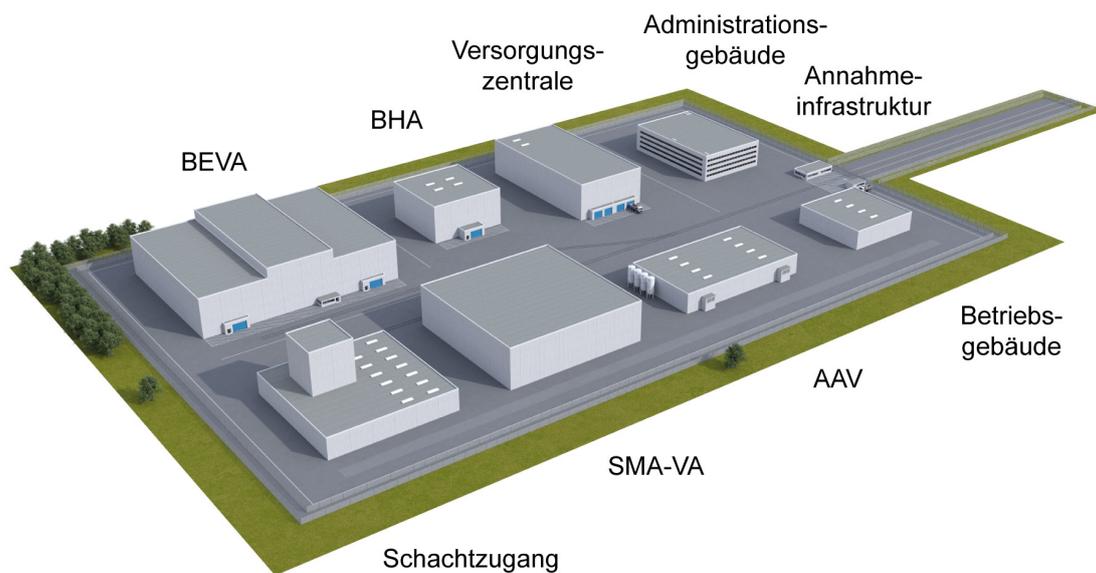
Darstellung der Oberflächenanlage eines Kombilagers
